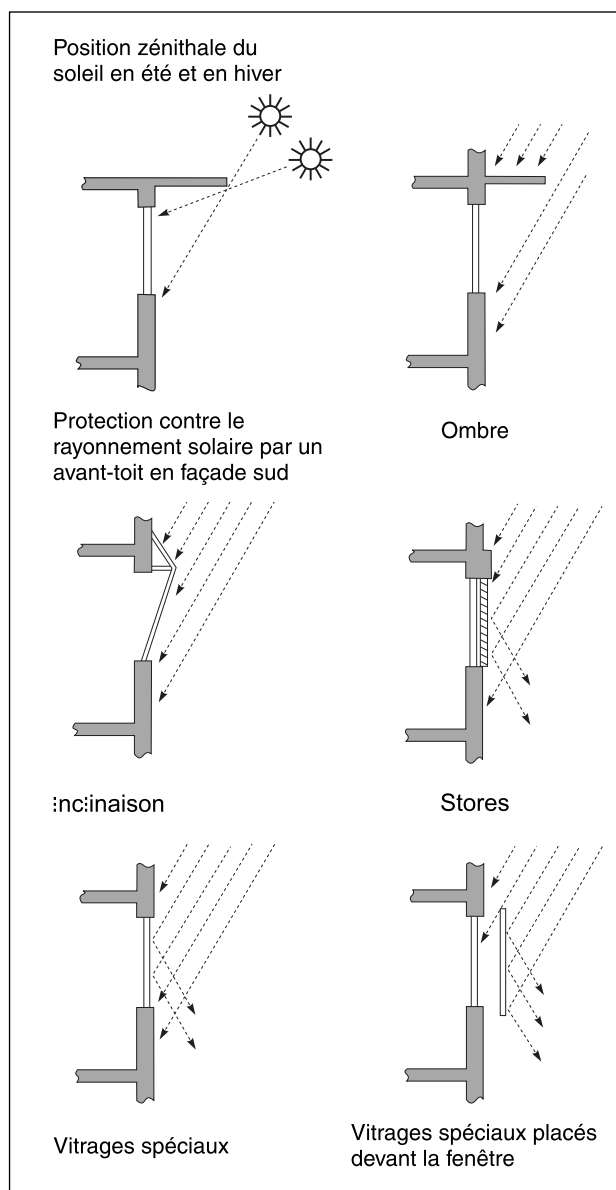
Exemples d'éléments pare-soleil en façade
